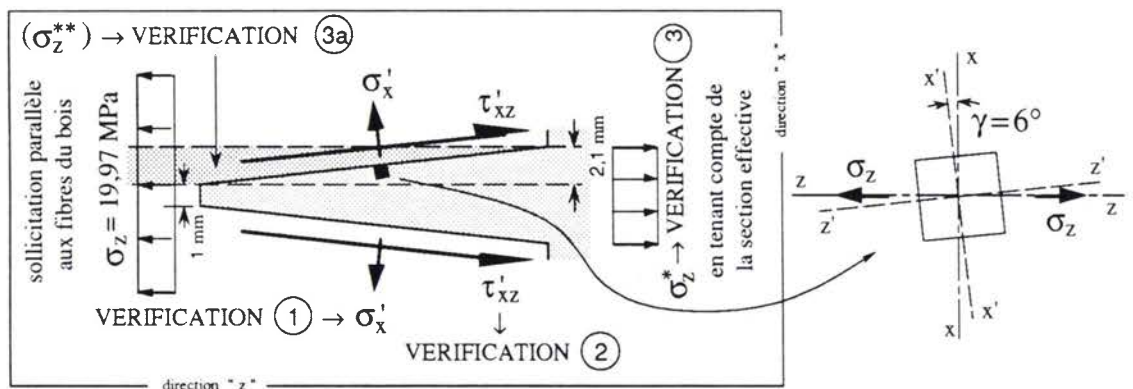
Section suivant un plan parallèle aux fibres du bois de la pièce de coin en contenant la section longitudinale des entures.
